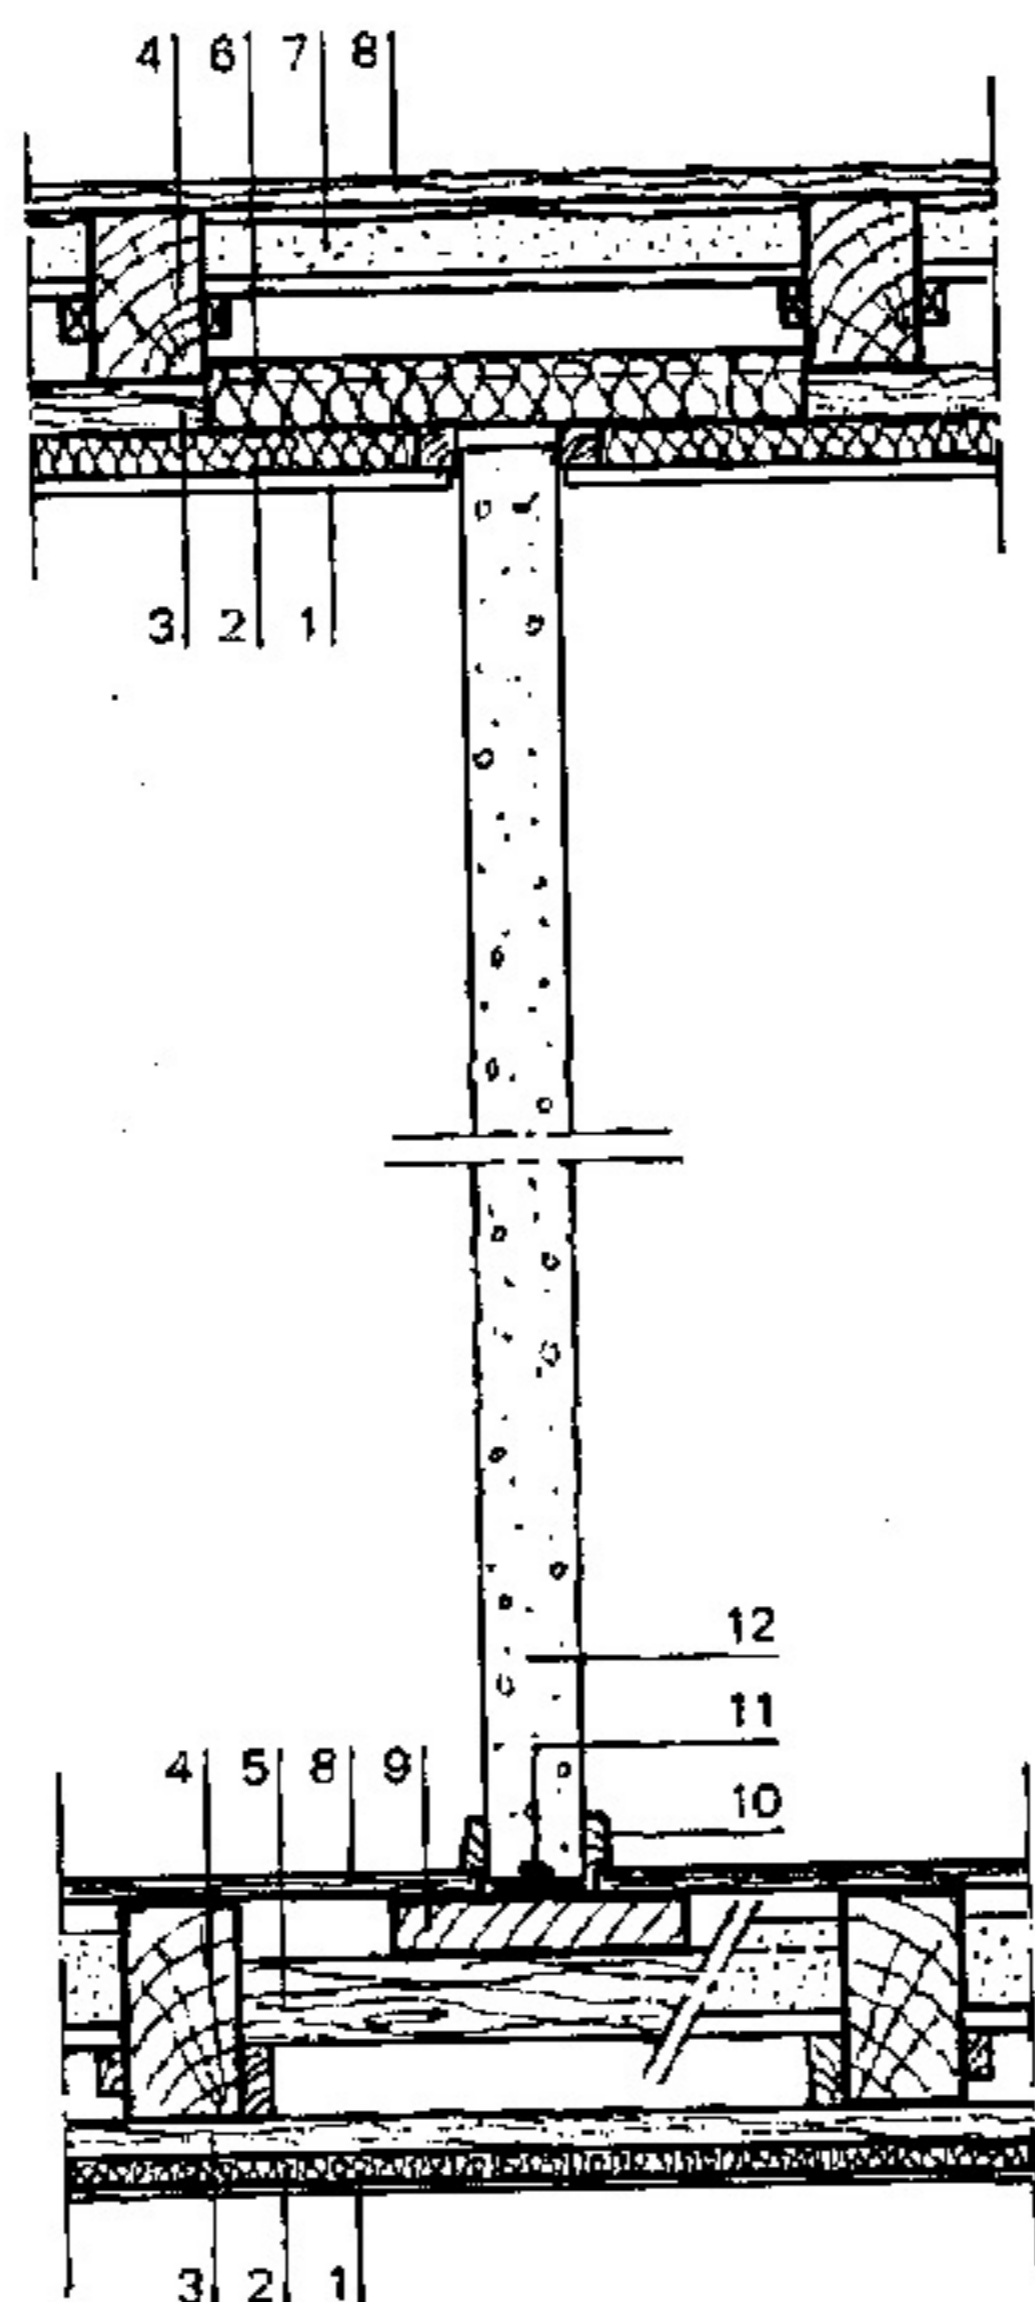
Perete despărțitor din ipsos fixat între planșee din lemn
